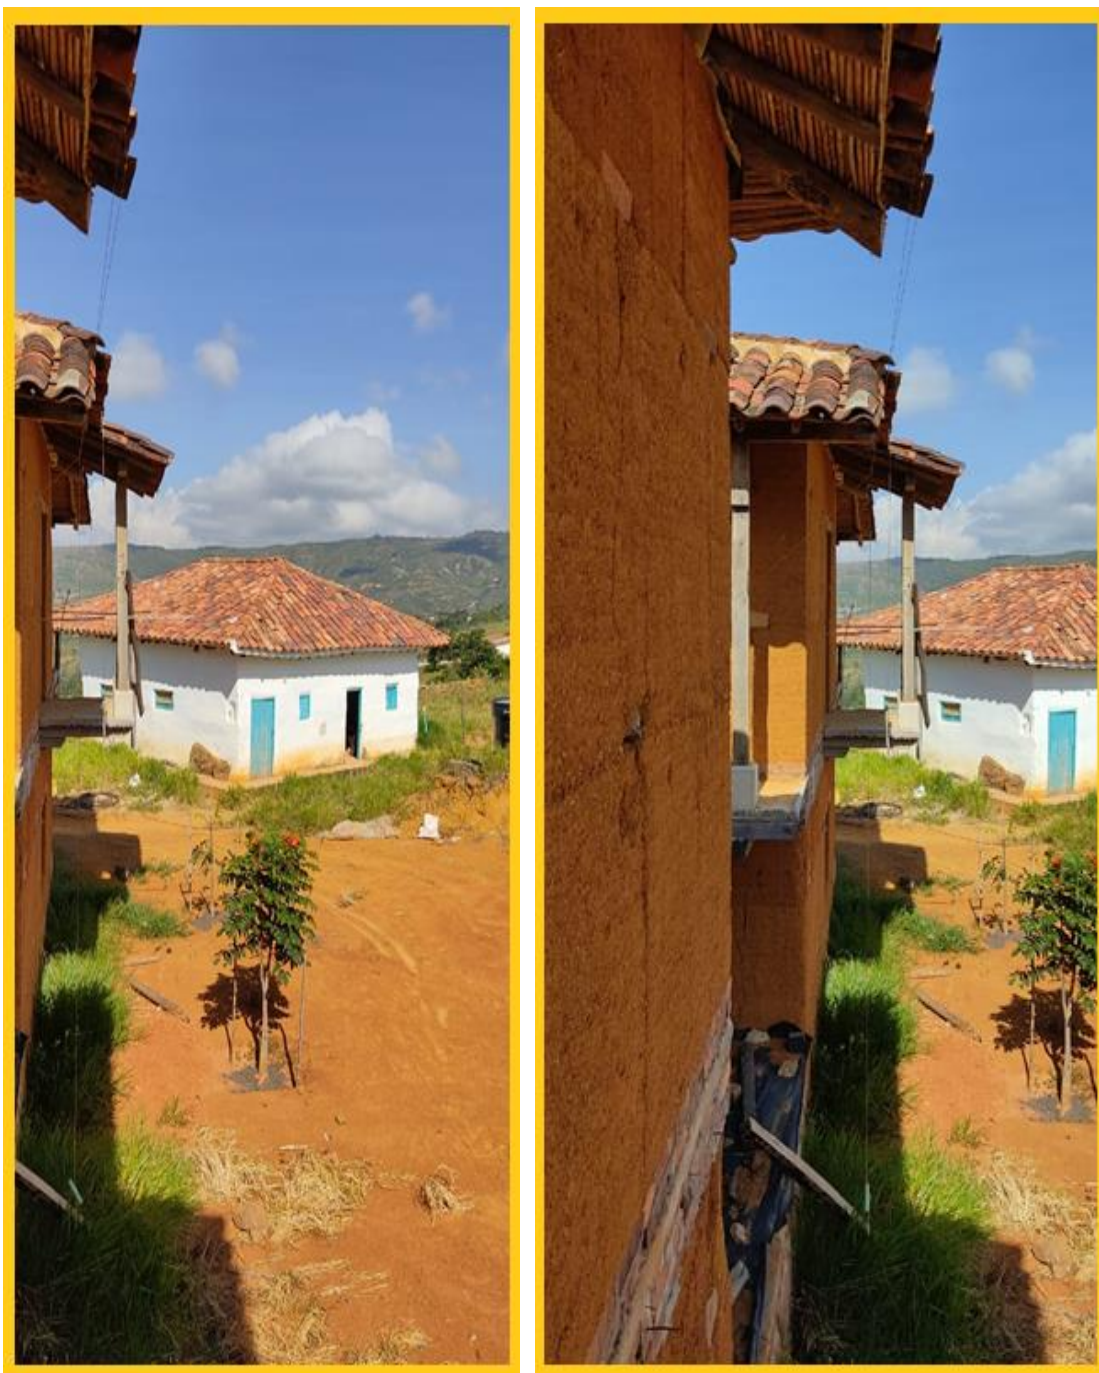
Casa de Dos pisos Construcción Maestro Ivan Ramírez
